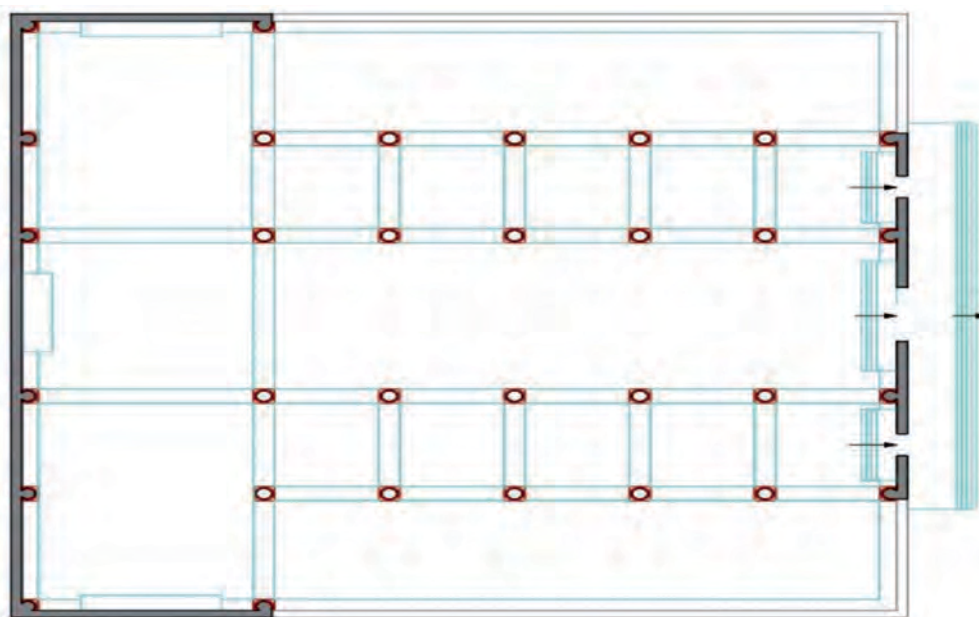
Pianta della chiesa della Pinta elaborata dall'Architetto Santi Gulisano utilizzando i dati pubblicati dall'Inveges
